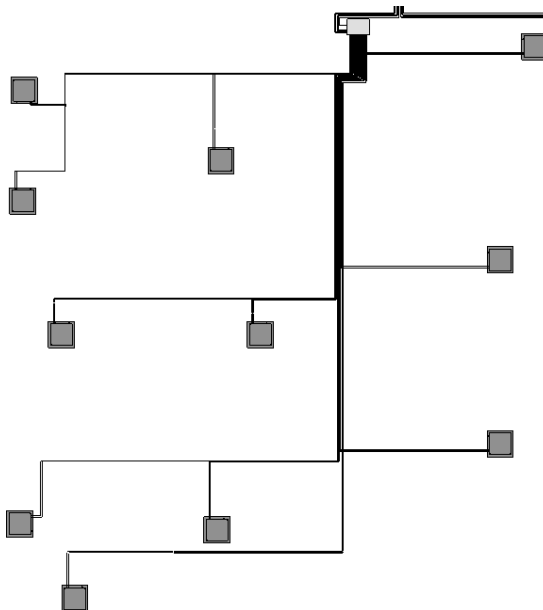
Detalle vista 3D circuito de ventilación Zona 1 planta baja.
